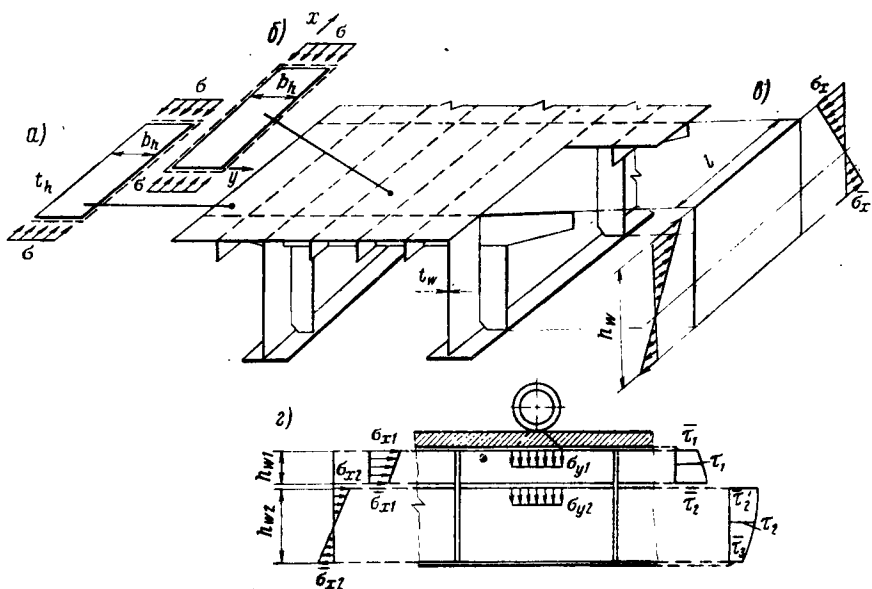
Схемы к расчету элементов плит и стенок на местную устойчивость
